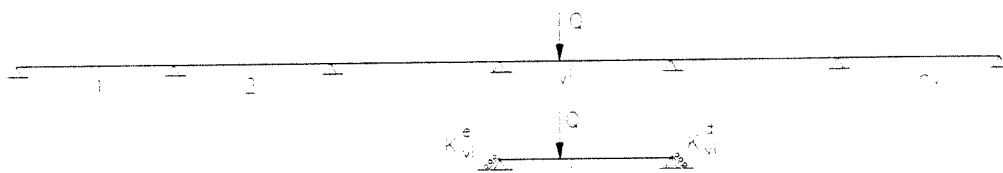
Substruturação de um tramo de uma viga contínua
